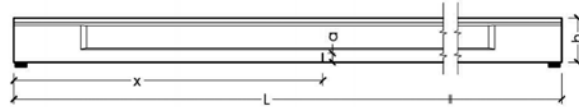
Vista longitudinal de la viga, con los parámetros de definición de la fisura.
